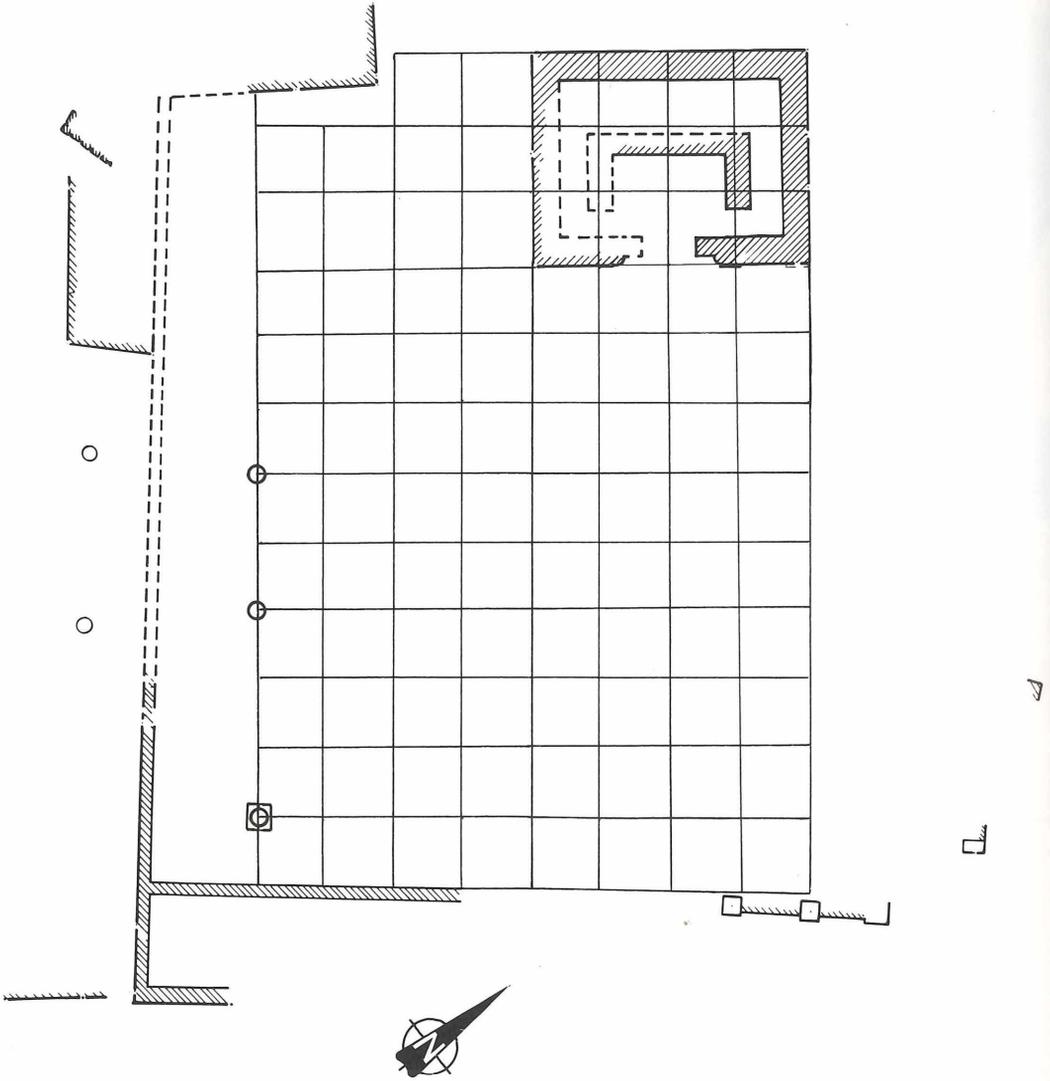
Grundriß der Anlage mit einem 2,5-m-Raster
